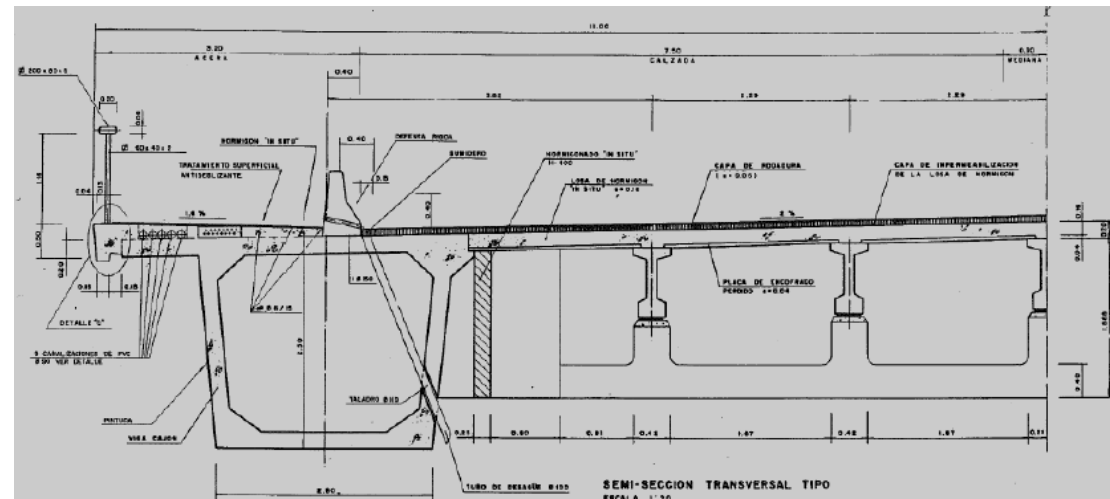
Detalle de semi-sección tipo en zonas riostra.
